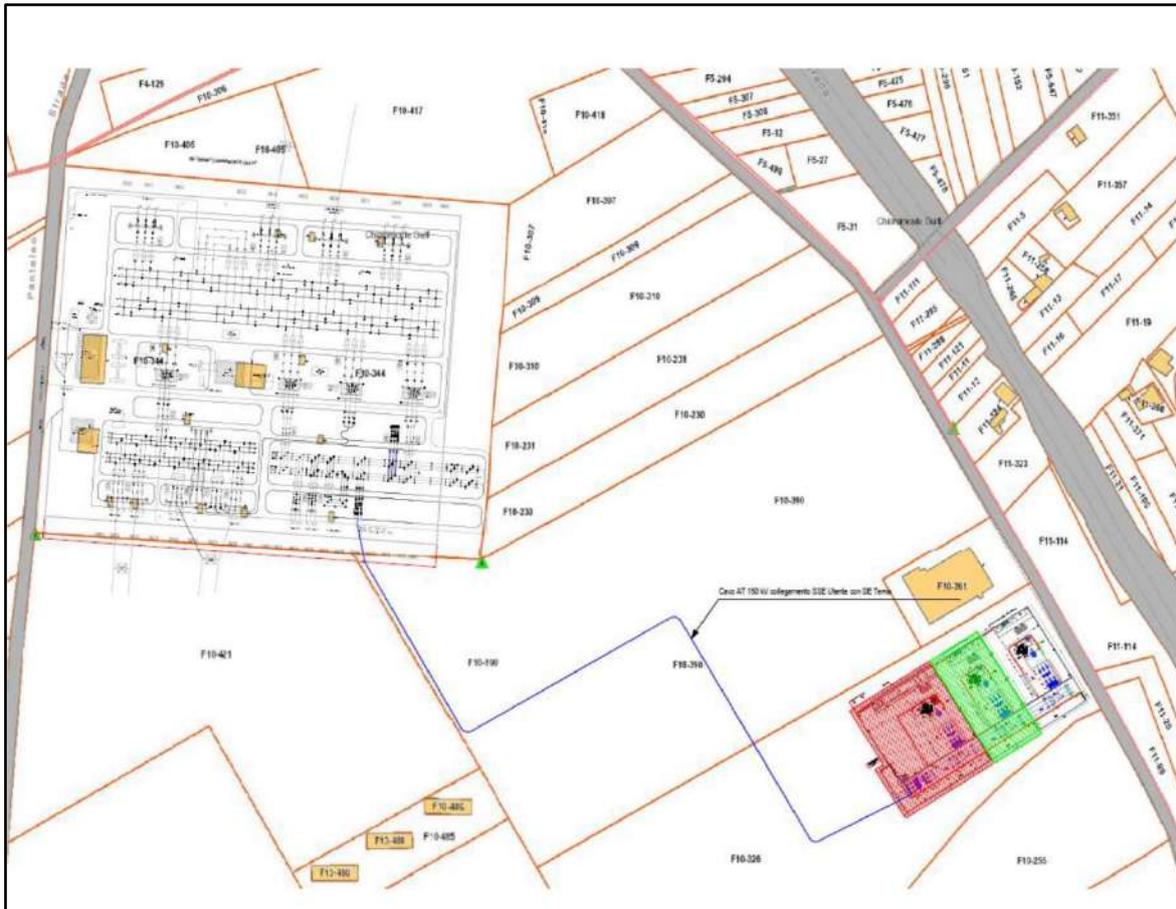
Planimetria generale delle opere di connessione previste in prossimità della Stazione Terna di Chiamonte Gulfi (RG). In verde l'area predisposta per la realizzazione della Stazione AT relativa all'impianto in oggetto, in rosso uno stallo pertinente ad altra società.
